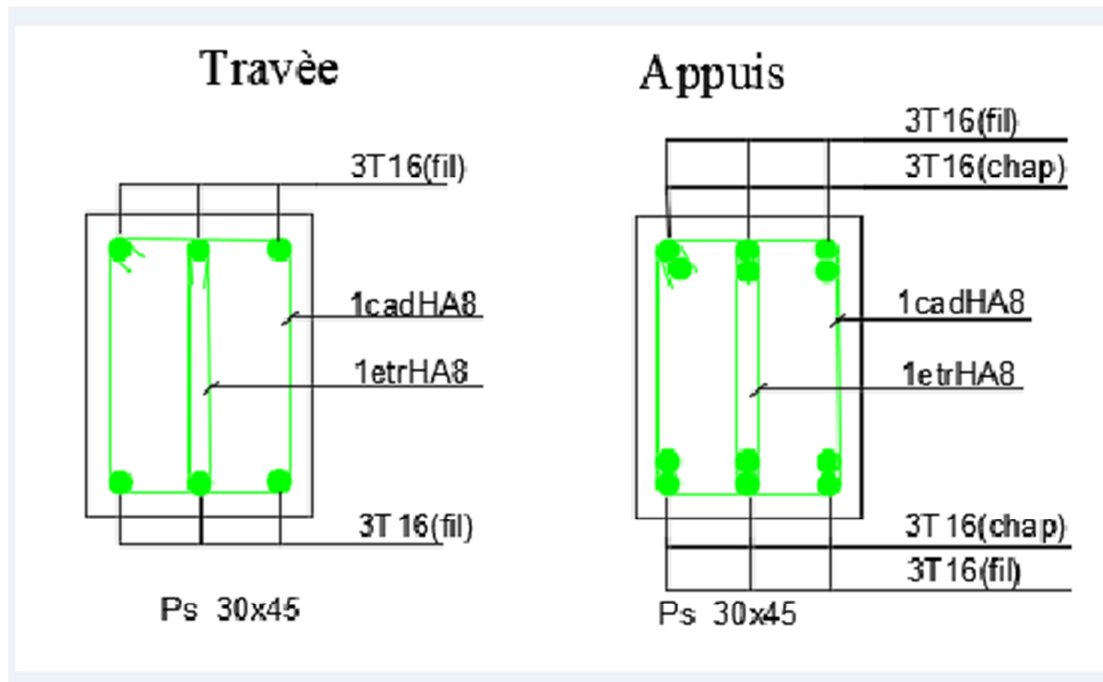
Schéma de ferraillage de poutre PS (30X45) cm
